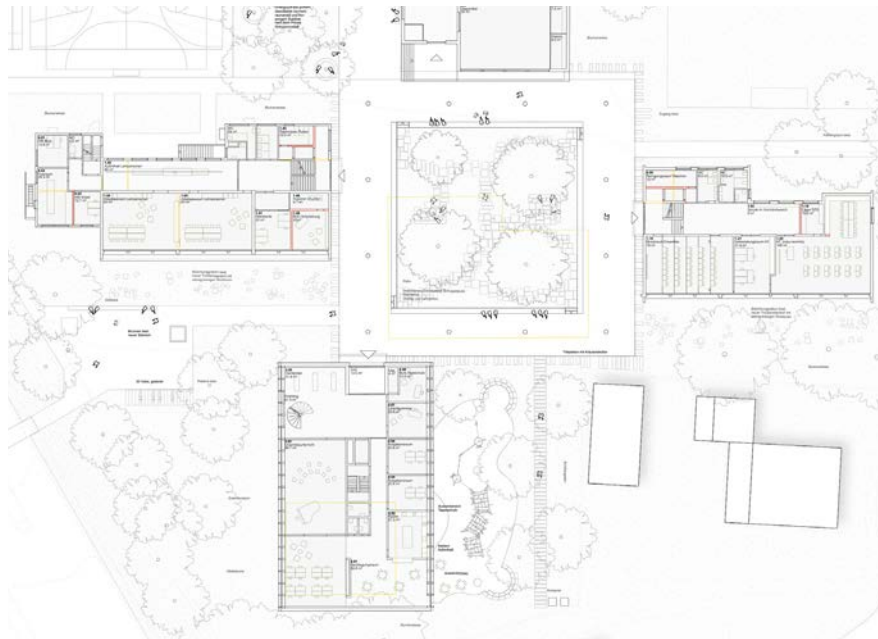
Schlussabgabe, Grundriss Erdgeschoss des Teams 1 Boegli Kramp
